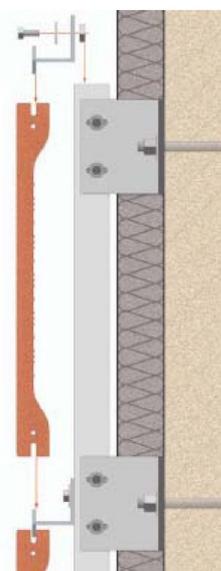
Particolare costruttivo e prospetto del sistema di facciata ventilata (Simoncini)
